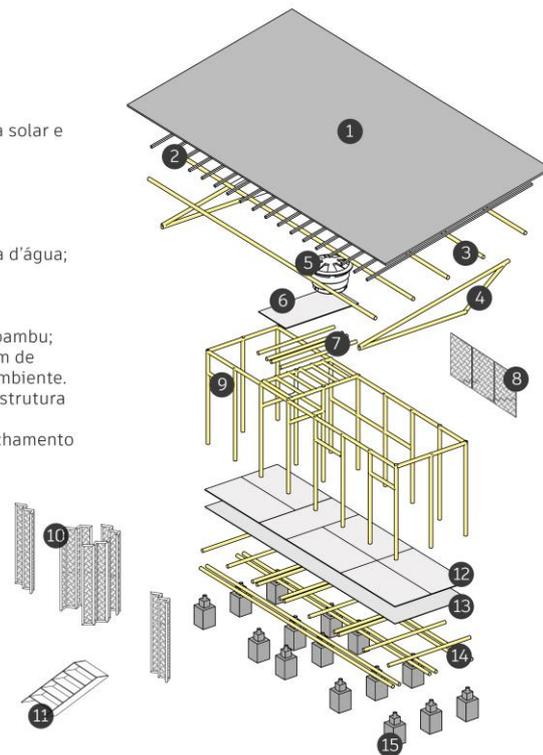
Perspectiva esquemática do projeto. Fonte: elaborado pelos autores.
